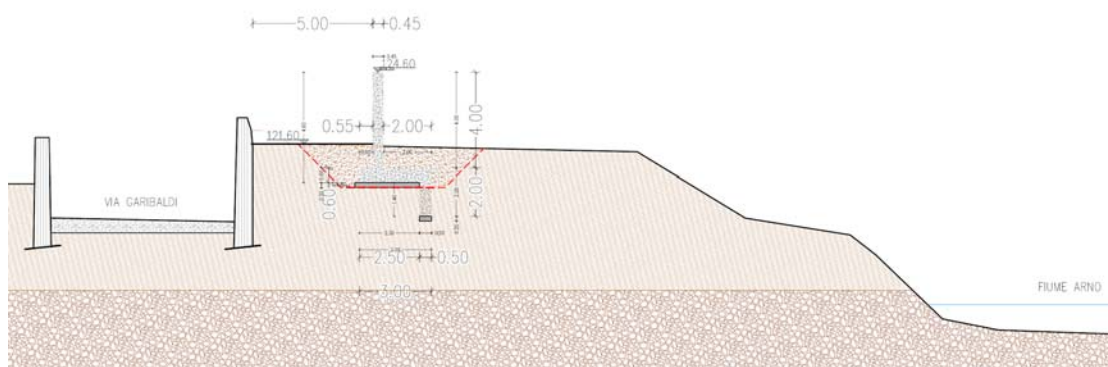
Sezione tipo intervento zona sottopasso Garibaldi
